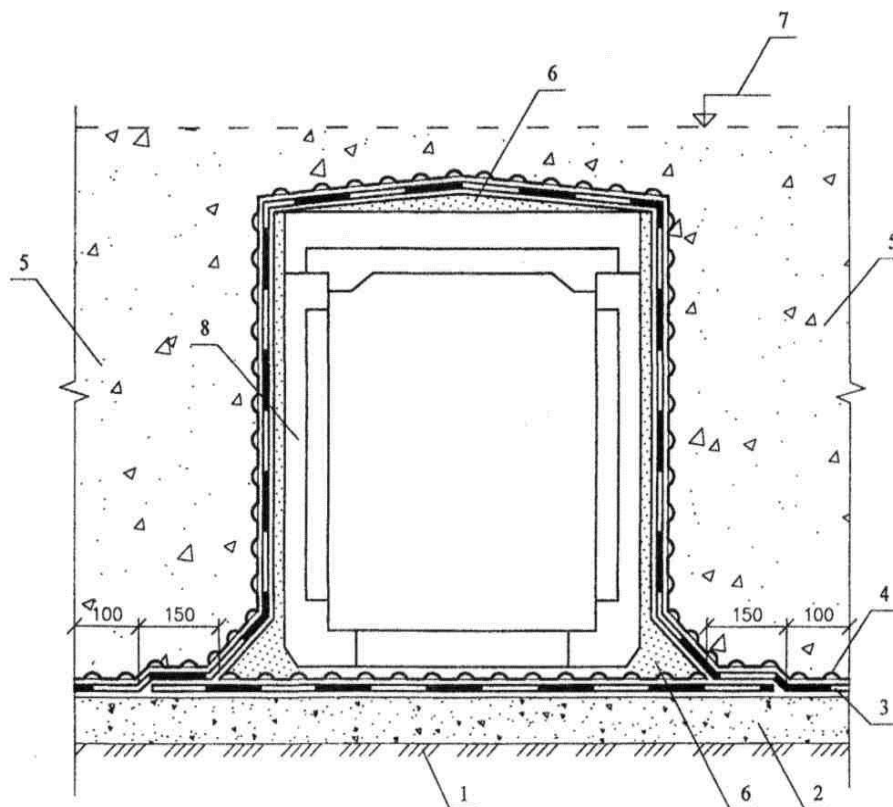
Гидроизоляция подземных сооружений от напора грунтовых вод:
